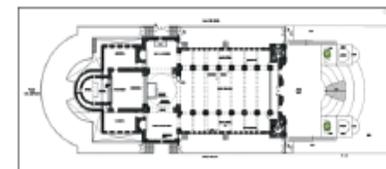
Plano Planta de la Catedral de Tacna (Velasquez, 2004)
